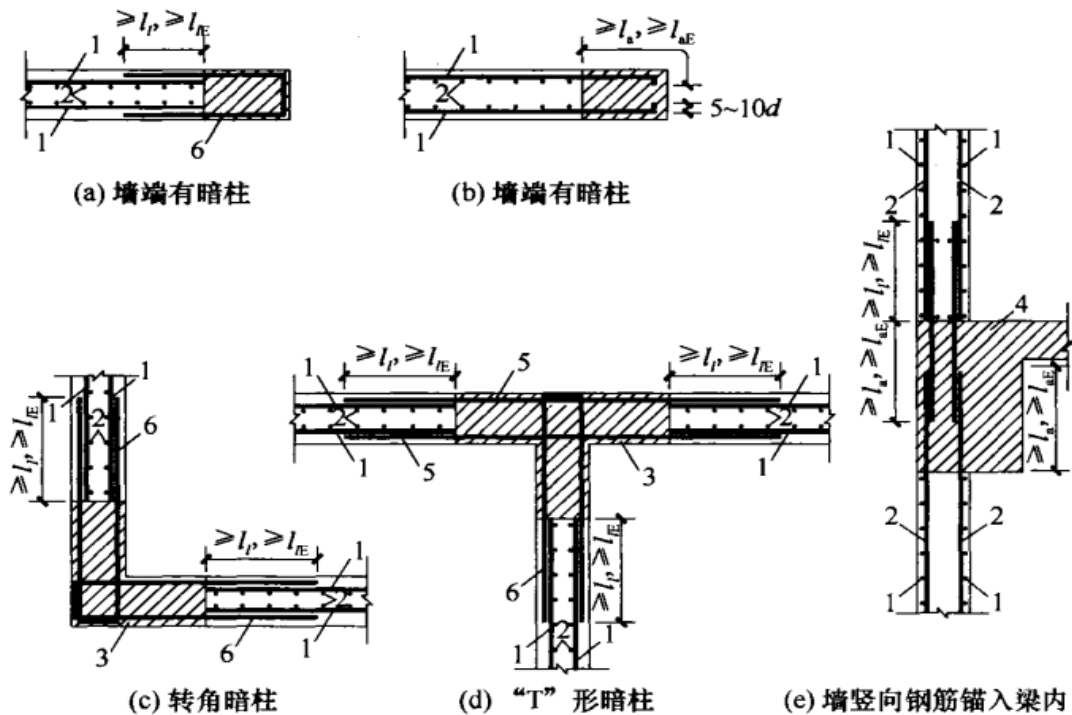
钢筋焊接网在墙体端部及交叉处的构造
